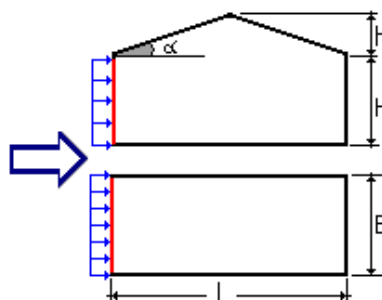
Ветровая нагрузка с наветренной стороны здания
